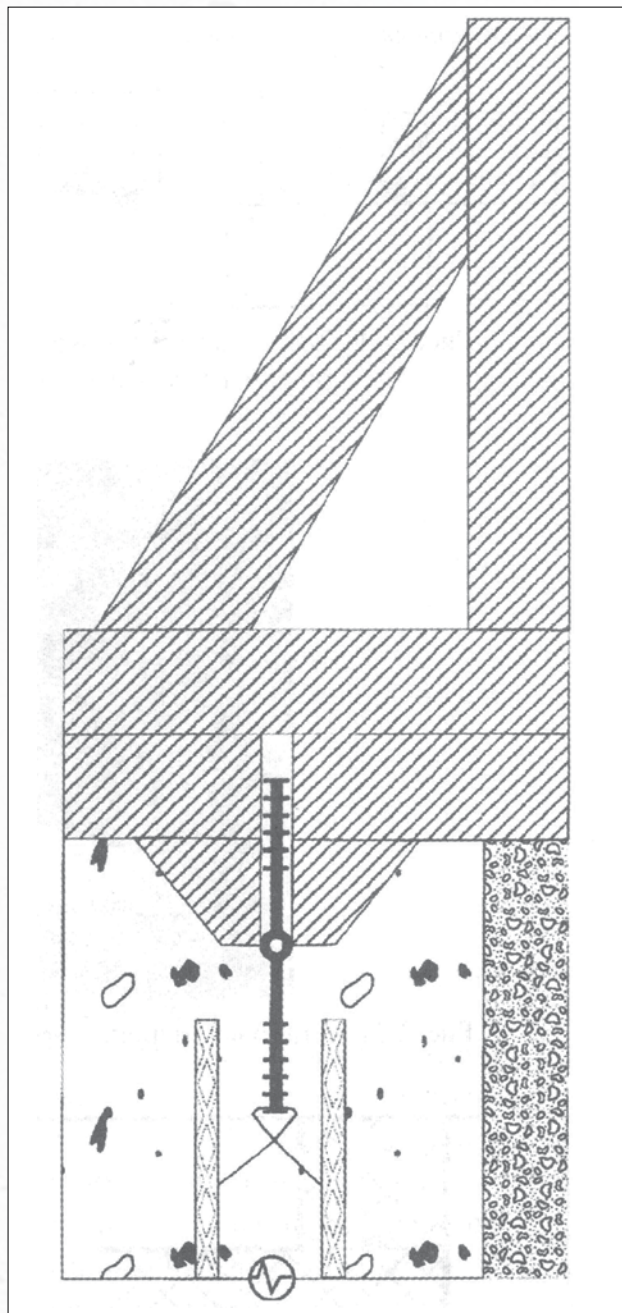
Установка гидрошпонки при укладке первой половины бетона
